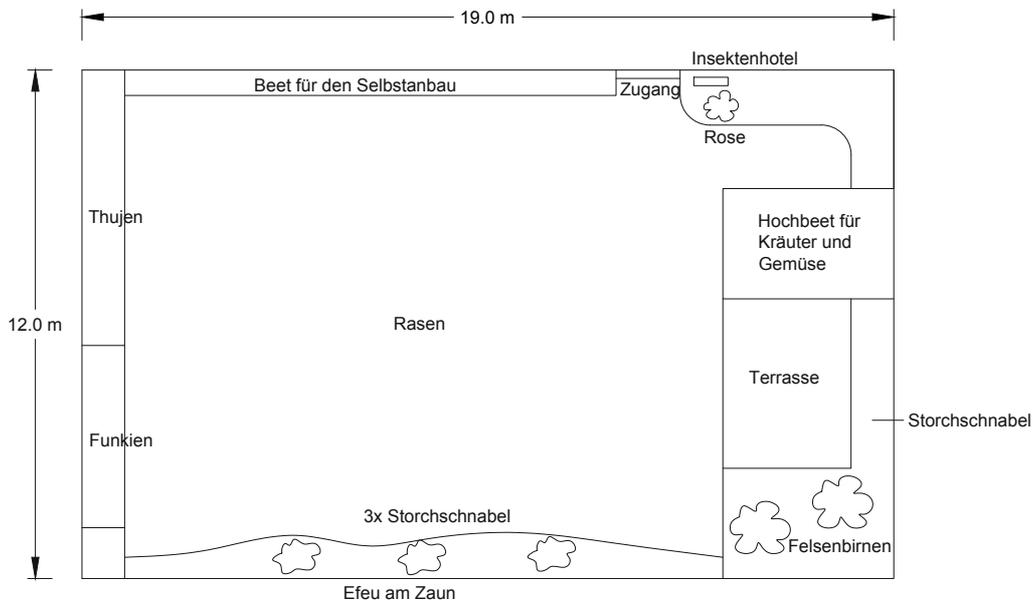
Skizze Innenhof Schubertgasse, eigene Darstellung © Elisabeth Zaussinger
